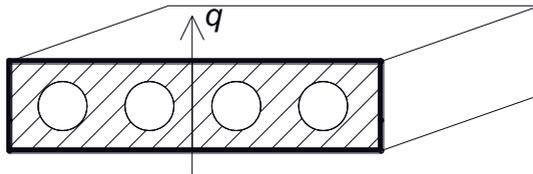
Конструкция плиты чердачного перекрытия
